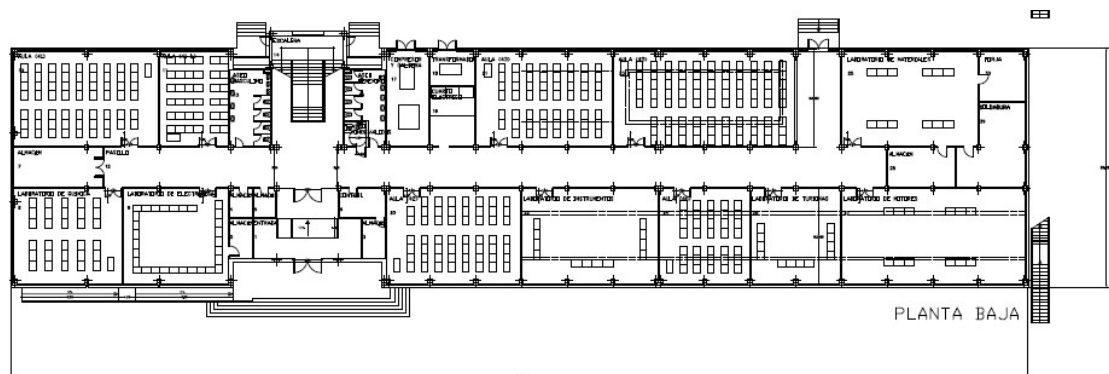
Planta de la planta baja del Isaac Peral. Fuente: ENM
